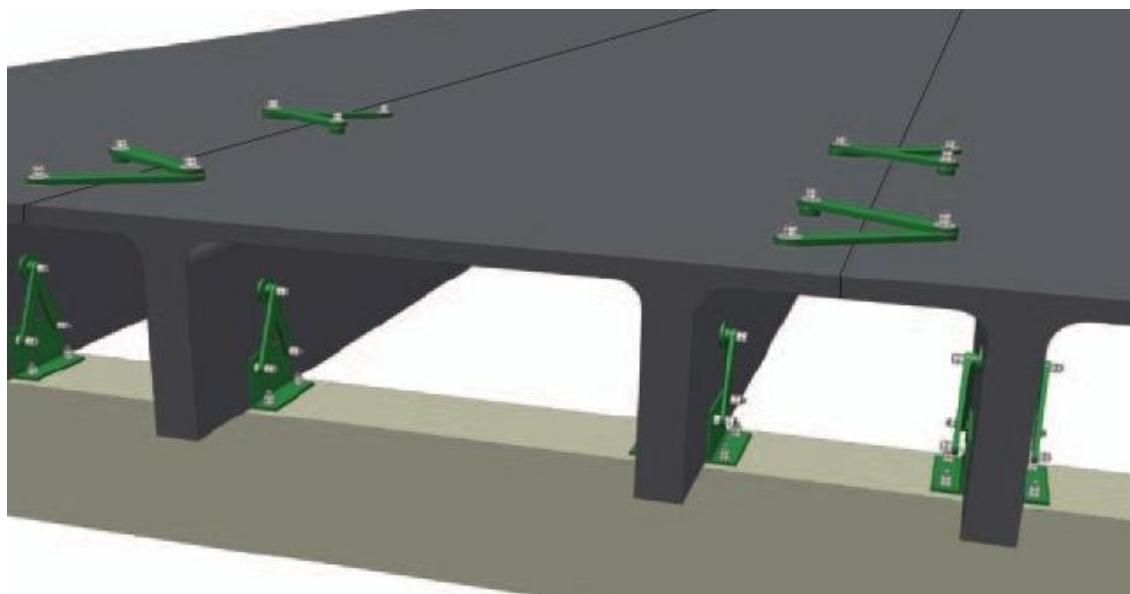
SICURLINK™ - Connessione tegolo-tegolo
